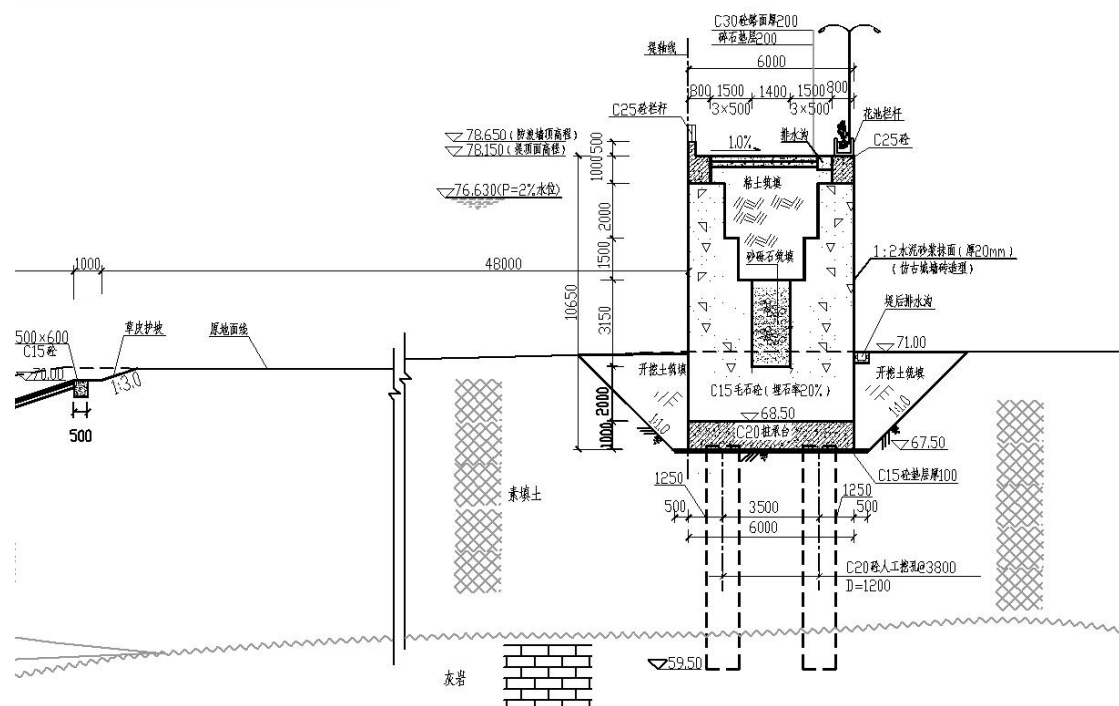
土石混合堤代表横剖面图 3（填土层较厚堤段）
